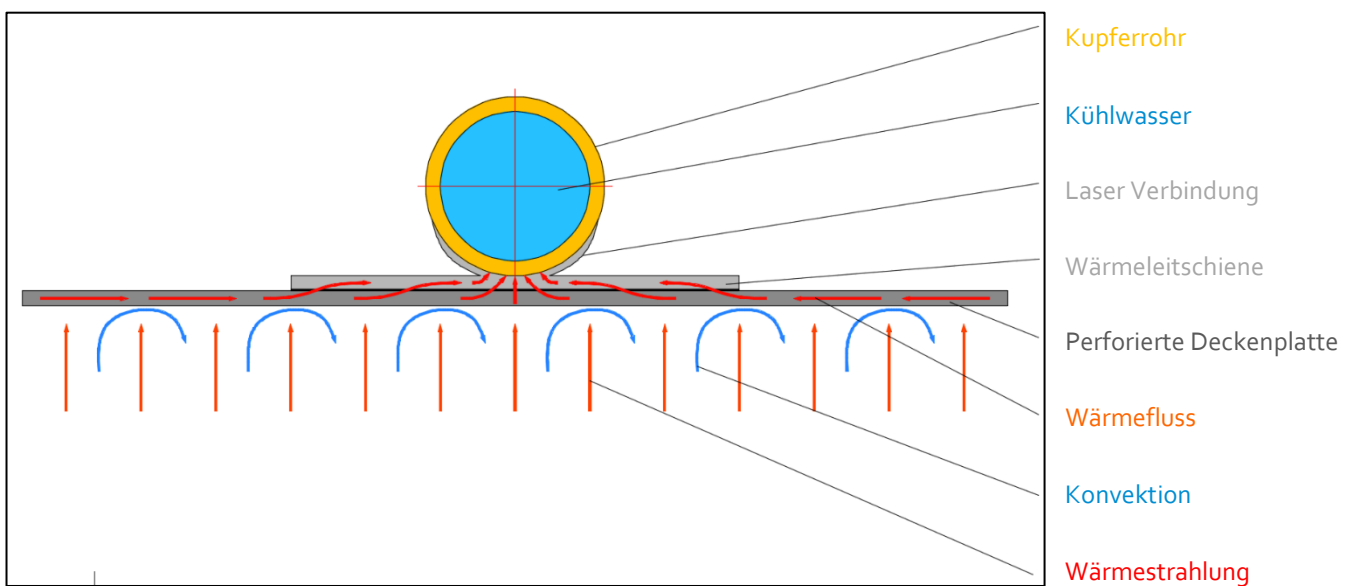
Grundlegende Funktionsweise einer Klimadecke
